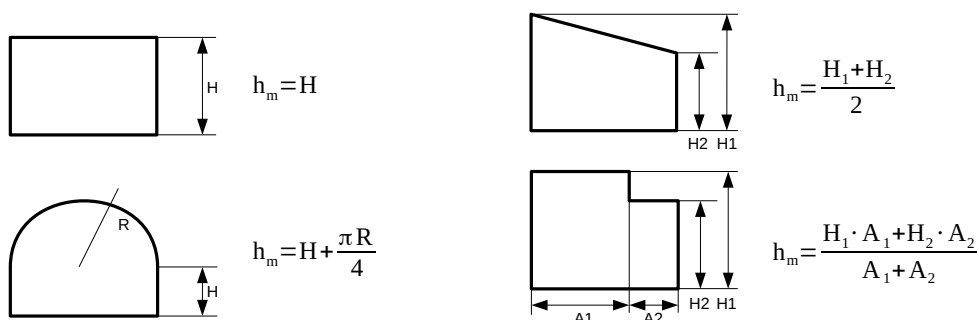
Esempi di determinazione dell'altezza media, in sezione
